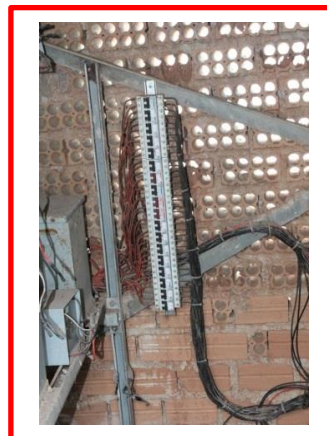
A 227: ESTRUTURA – TORRE 4
